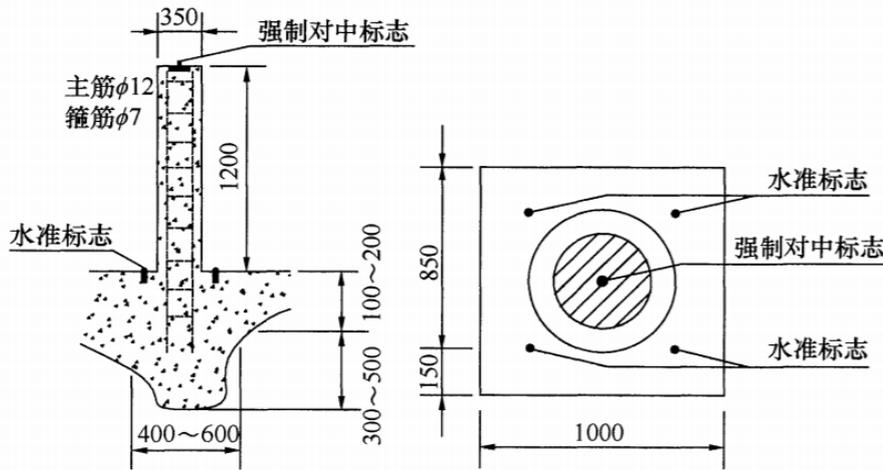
岩层水平位移观测墩剖面图与俯视图（单位：mm）
